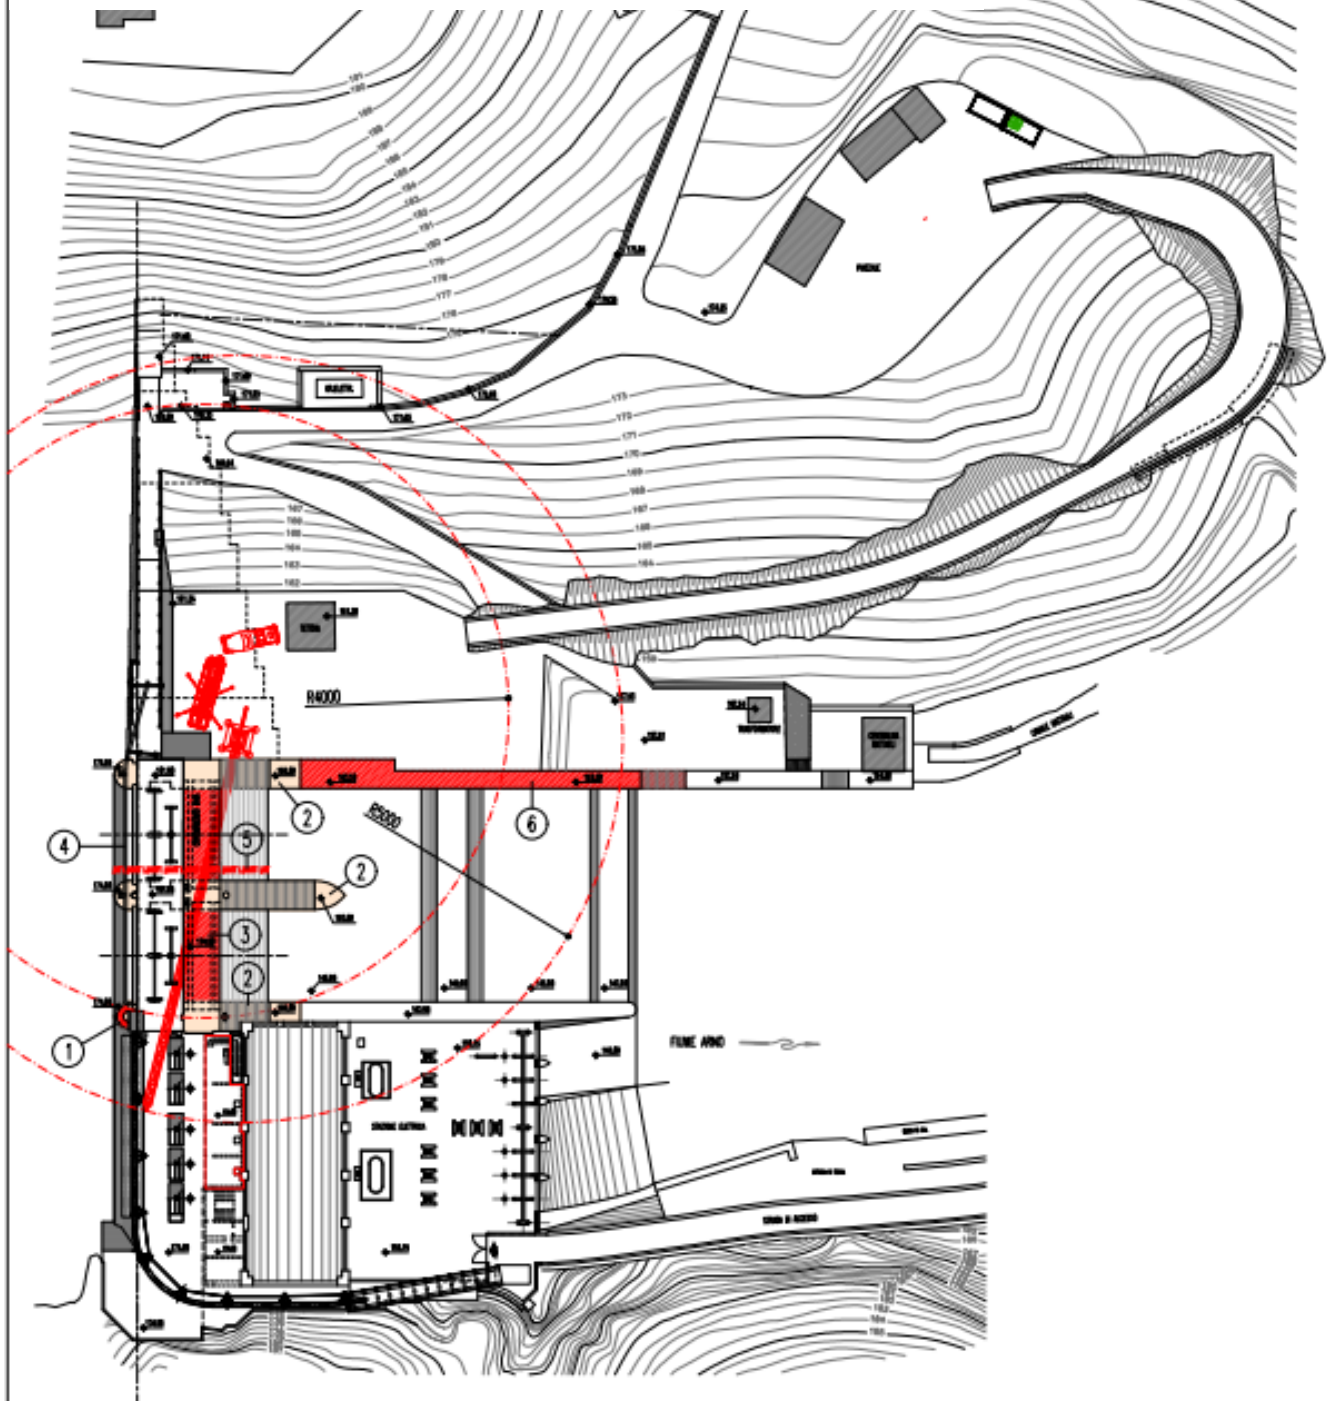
3 – Estratto planimetrico elaborato progettuale – Cantierizzazione FASE 3
